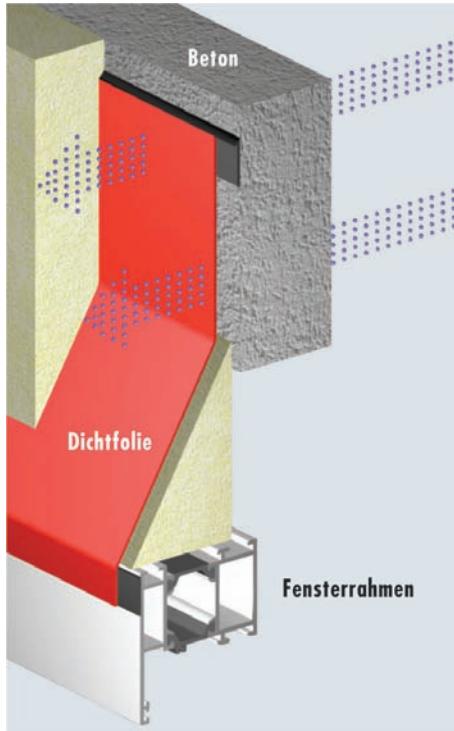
Einbau Fassade: Die dampfdiffusionsdichte Folienbahn einzubauen, die verhindert, dass Feuchtigkeit in den Fugenbereich eindringt.
